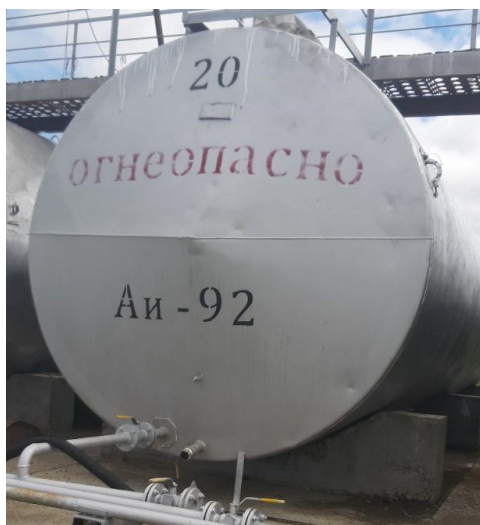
Общий вид резервуаров РГС-60 №20
